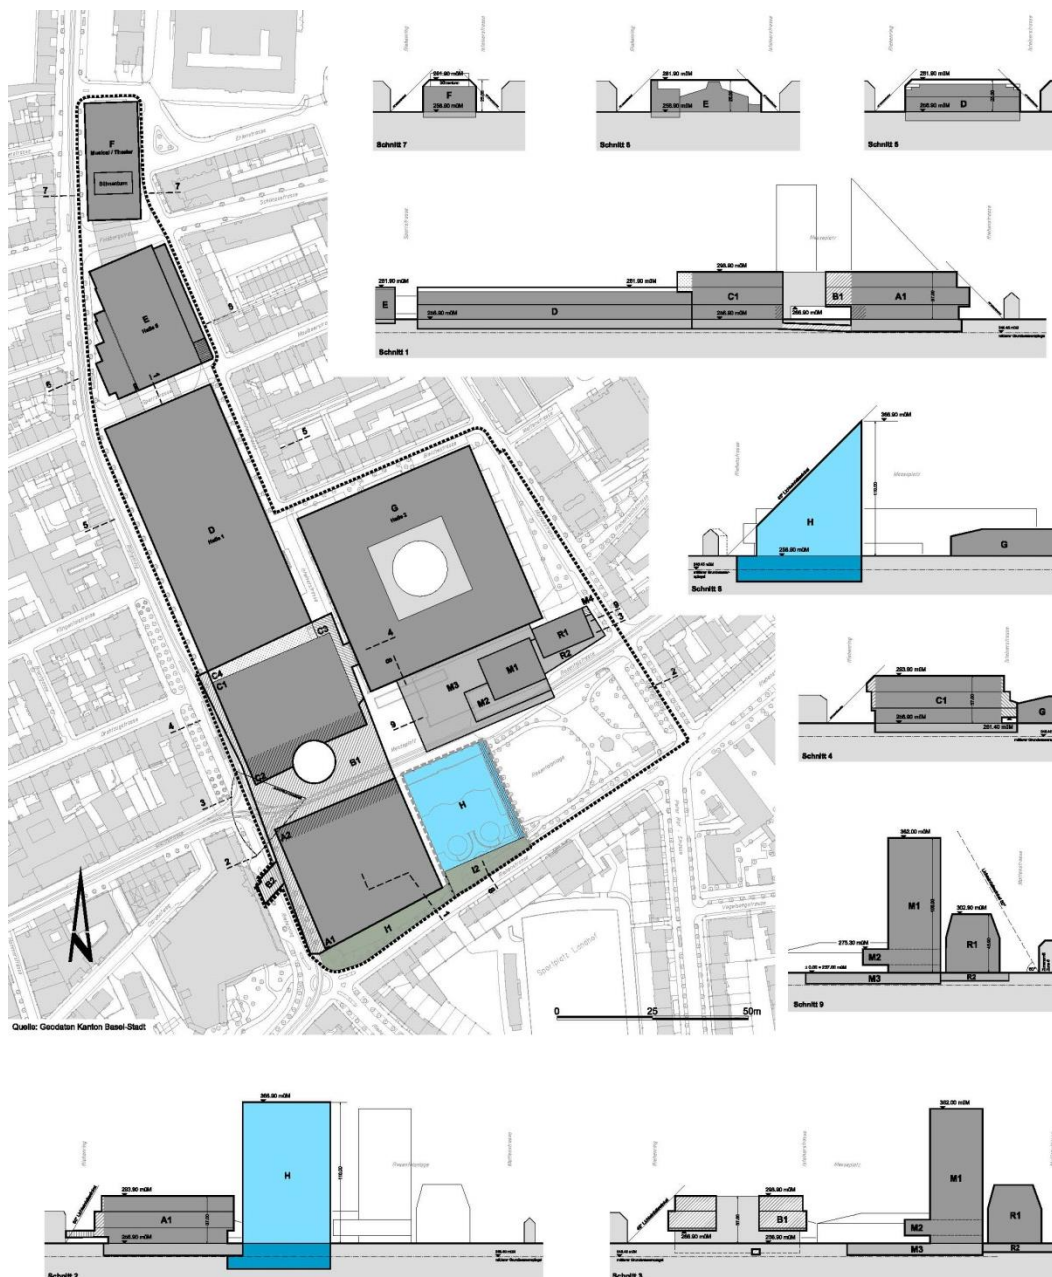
PI-Nr. 13'241 Entwurf Änderung best. Bebauungsplan Nr. 182 mit neuem Planungs- und Projektperimeter
